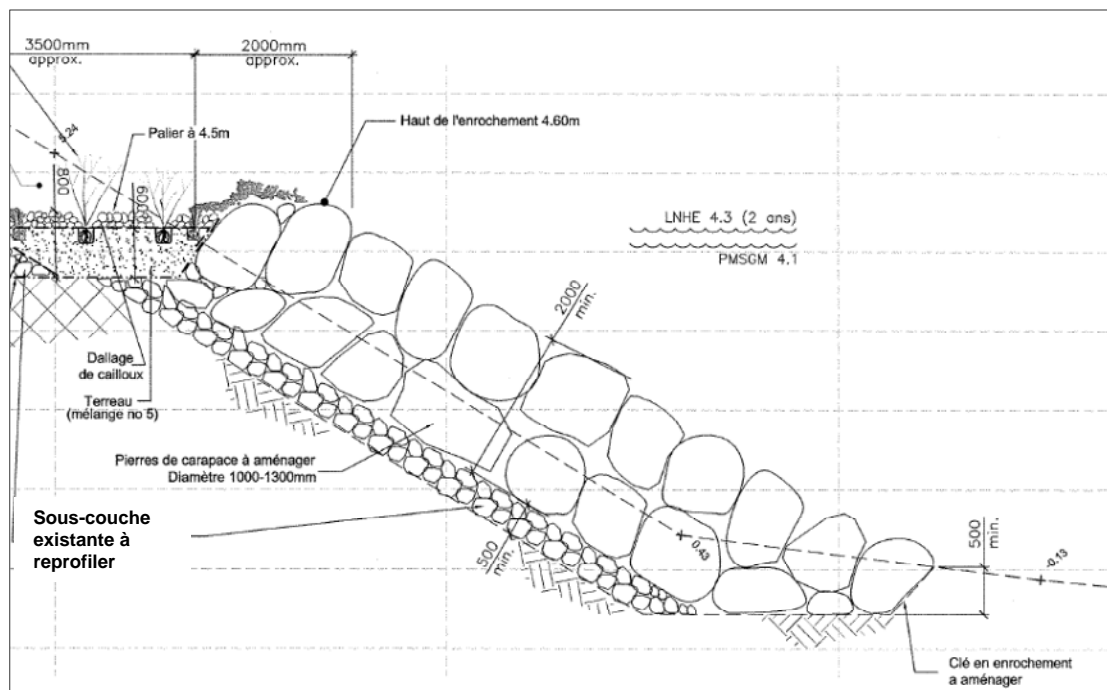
Coupe-type d'une reconstruction de la couche de carapace.
